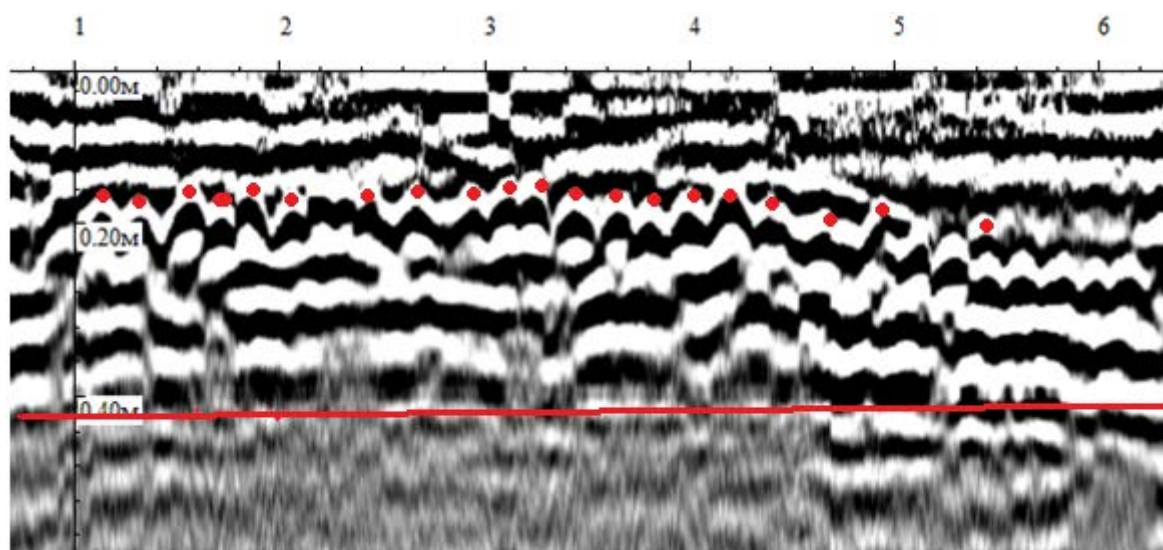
Пример обнаружения арматуры в бетонной плите.
